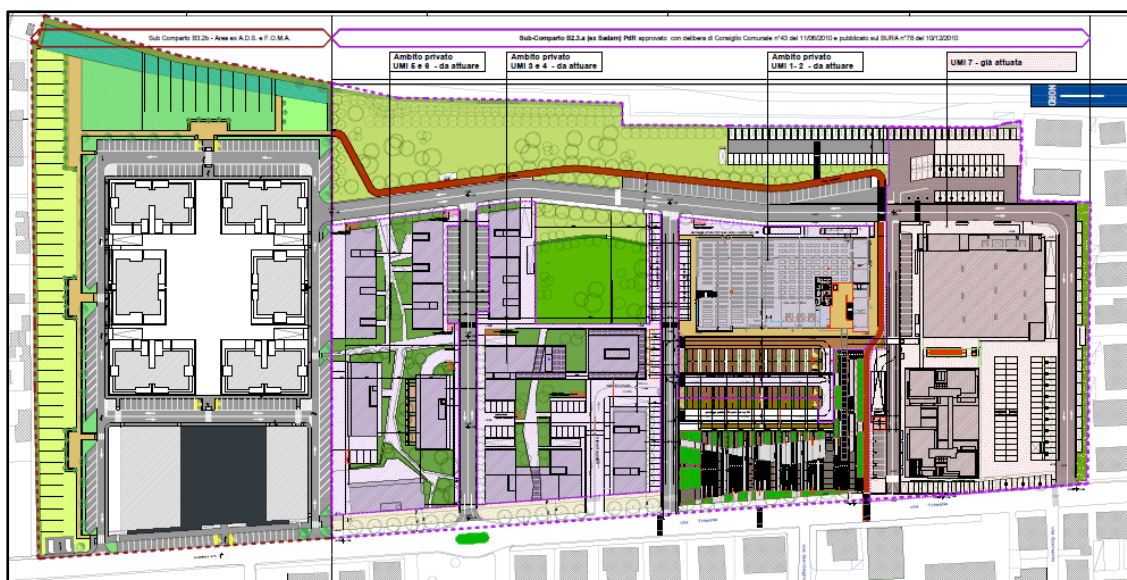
Planimetria di contesto- Ambito ex Foma ed ex Sadam
